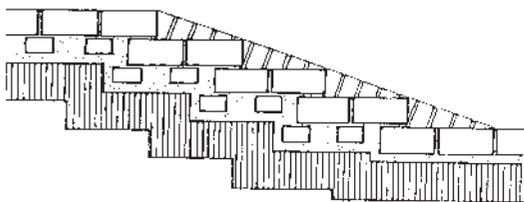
Adoquines cerámicos de pavimento acoplados, con inclinación hormigonada, a la zona de mampostería.
